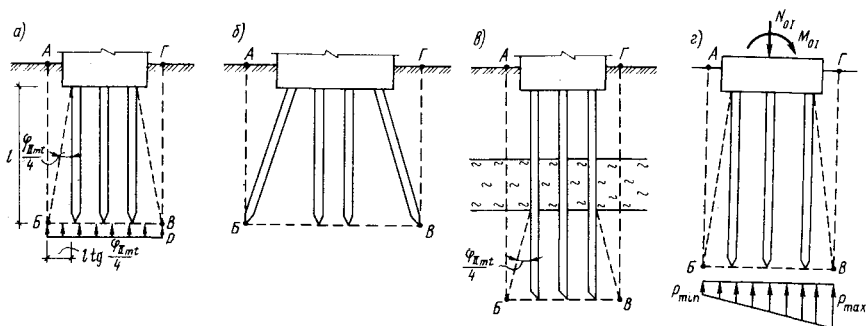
Схемы условных фундаментов для расчета по второй группе предельных состояний
